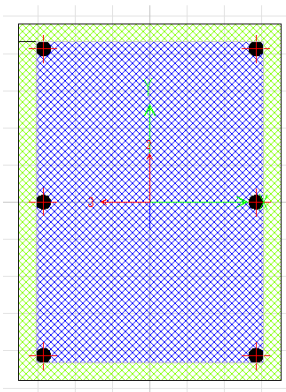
Modellazione della sezione di calcestruzzo armato
